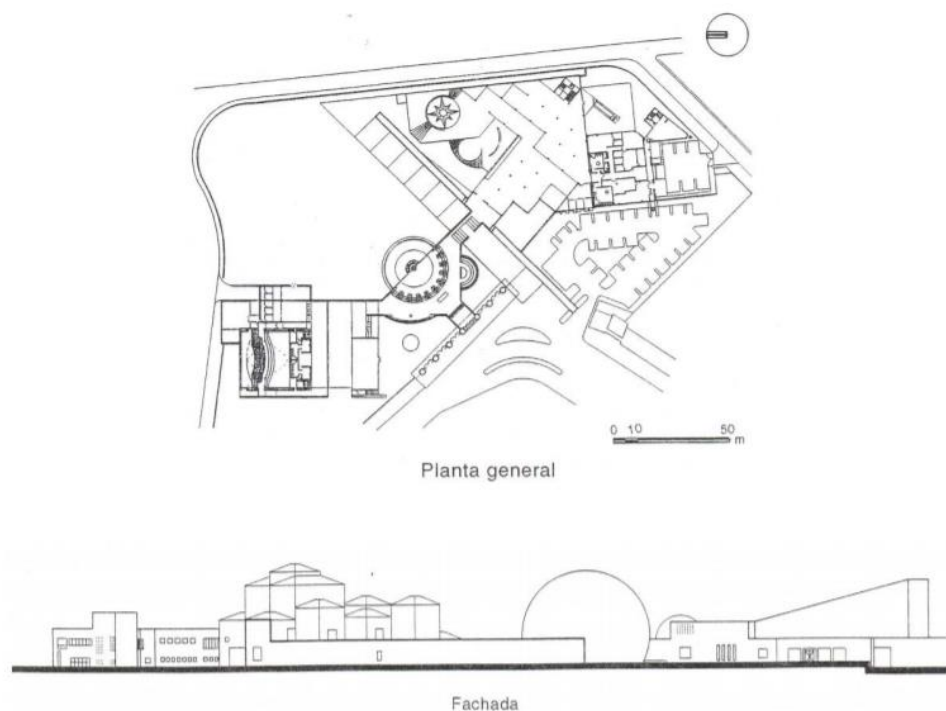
Planta y alzado papalote museo del niño. Imagen obtenida en arquitecturapanamericana.com
